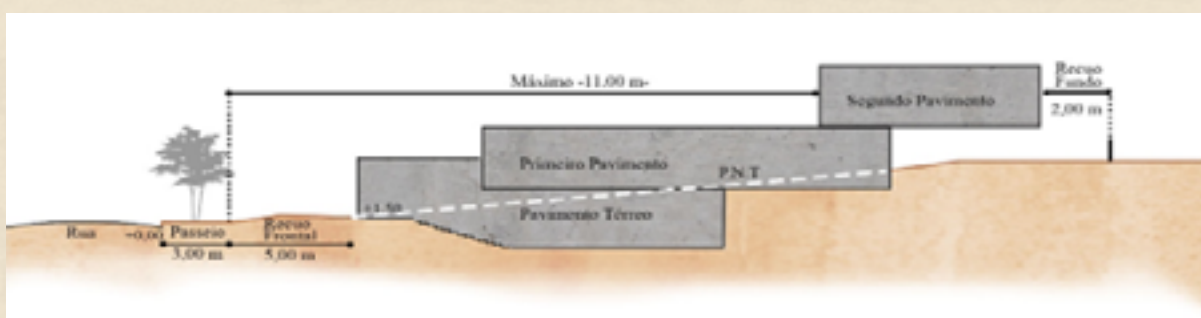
Construção com 3 Pavimentos para Lotes com Active
